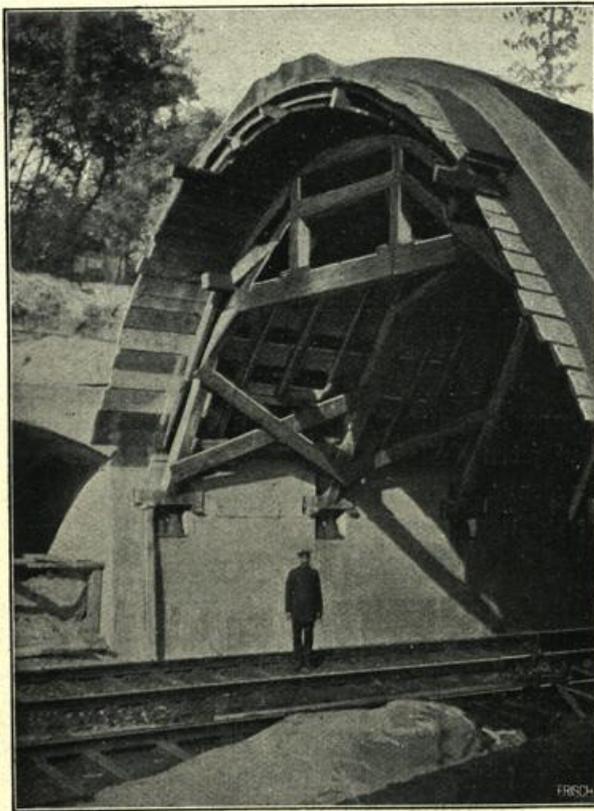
Tunnelingang mit eingebautem Stampfgerüst (Betonbau).
